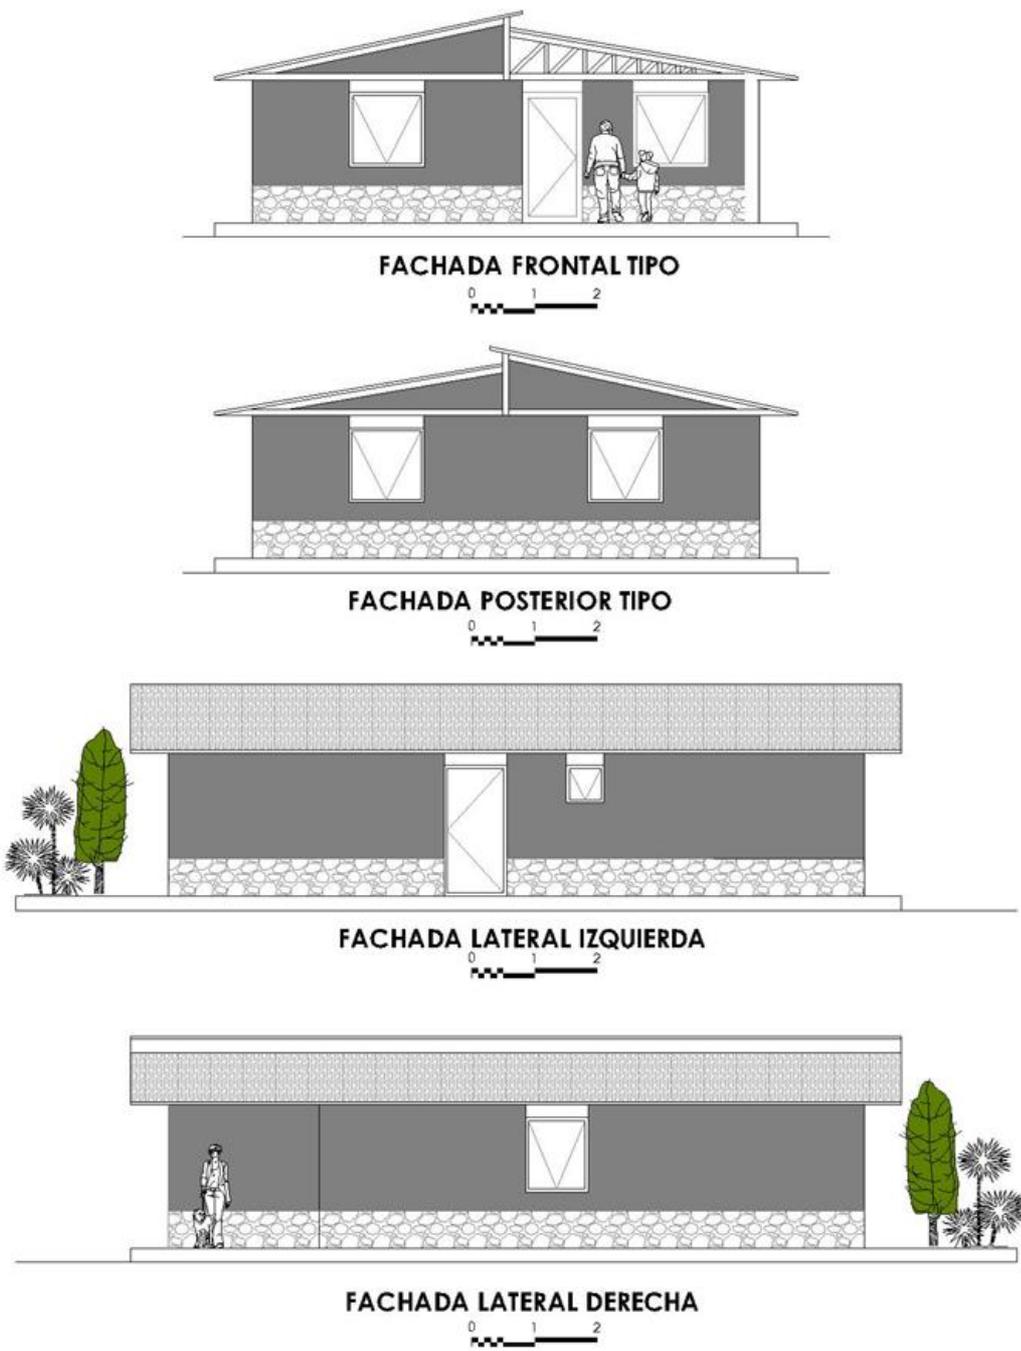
Fachadas (Modelo con Súper Adobe).
